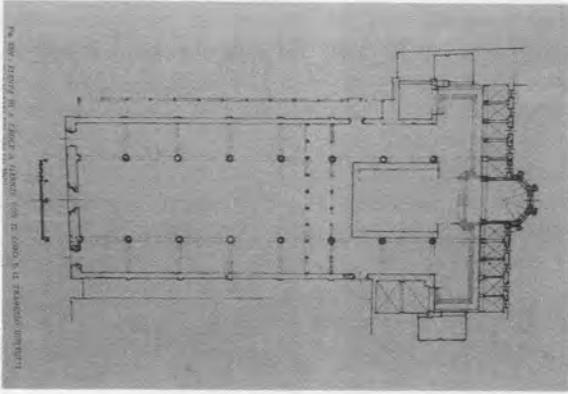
Planta de Santa Croce de Florencia con el tramezzo divisorio de la nave.
